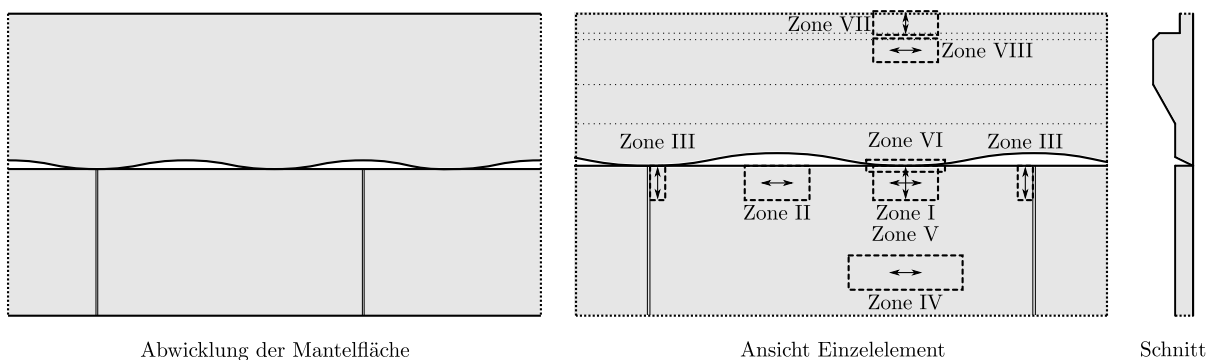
Einteilung hoch beanspruchter Bereiche in Zonen; Stoßfuge mit drei angrenzenden Betonsegmenten
